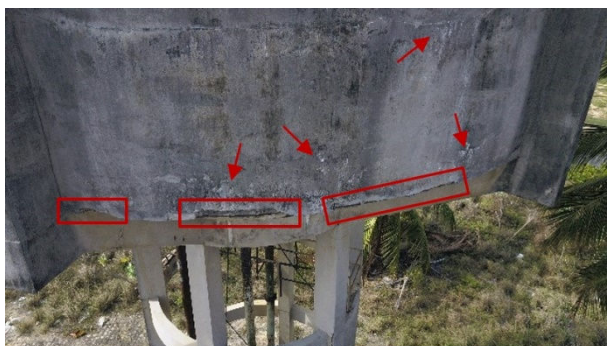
Parede da cuba (face sudeste) com manchas de umidade, em destaque corrosão da armadura (retângulos) e eflorescências (setas)
